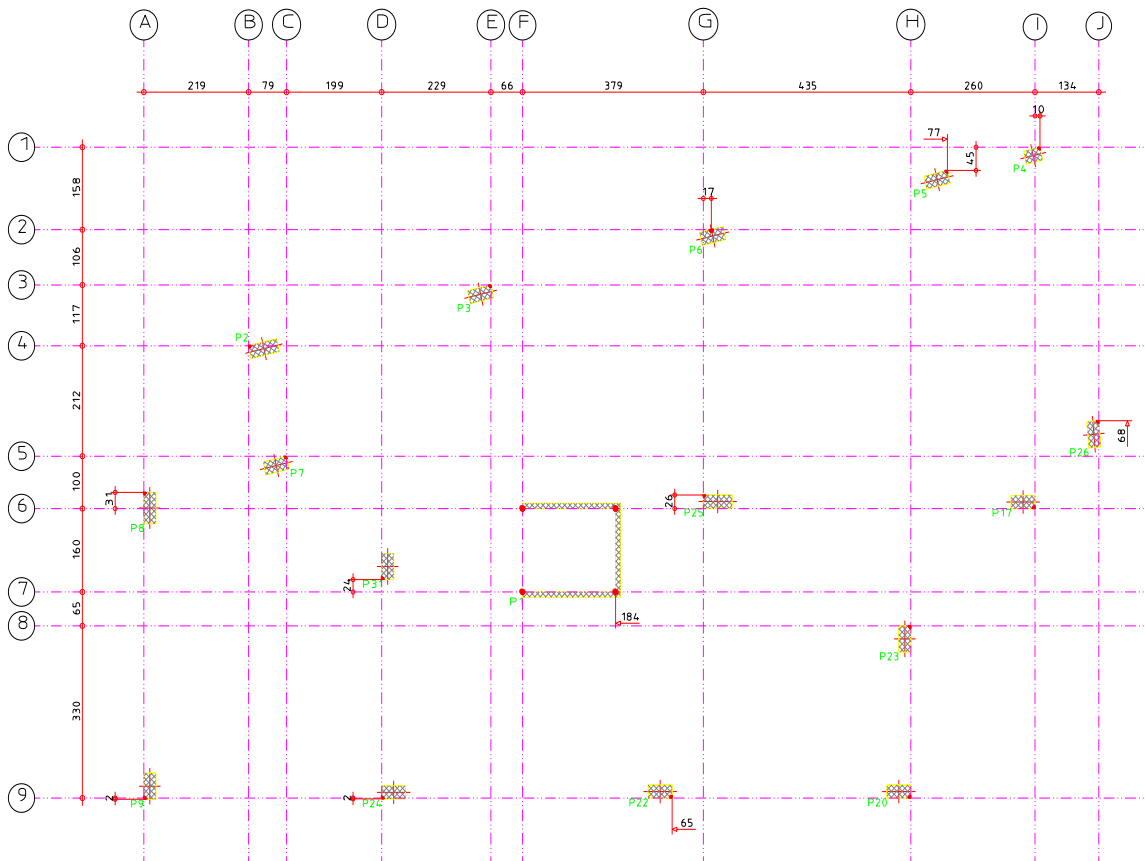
Planta de Implantação dos pilares (Nova Faceta)
